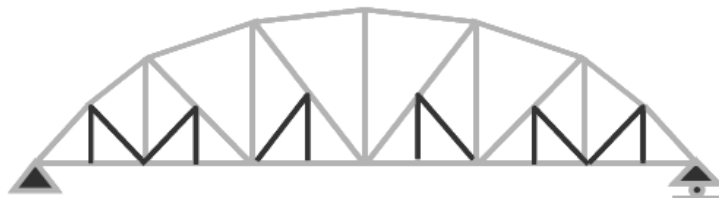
Jembatan Rangka Tipe *Subdivided Pratt Truss with Substruts or Baltimore Truss
